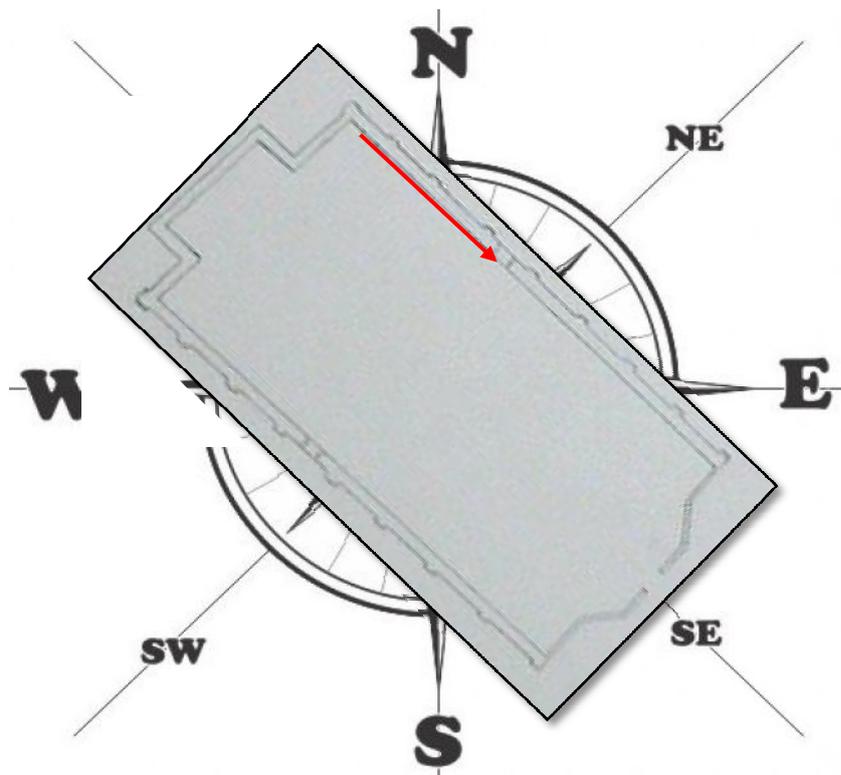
Planta baixa da Igreja, destacando a fachada de estudo, norte, na orientação cardeal.
